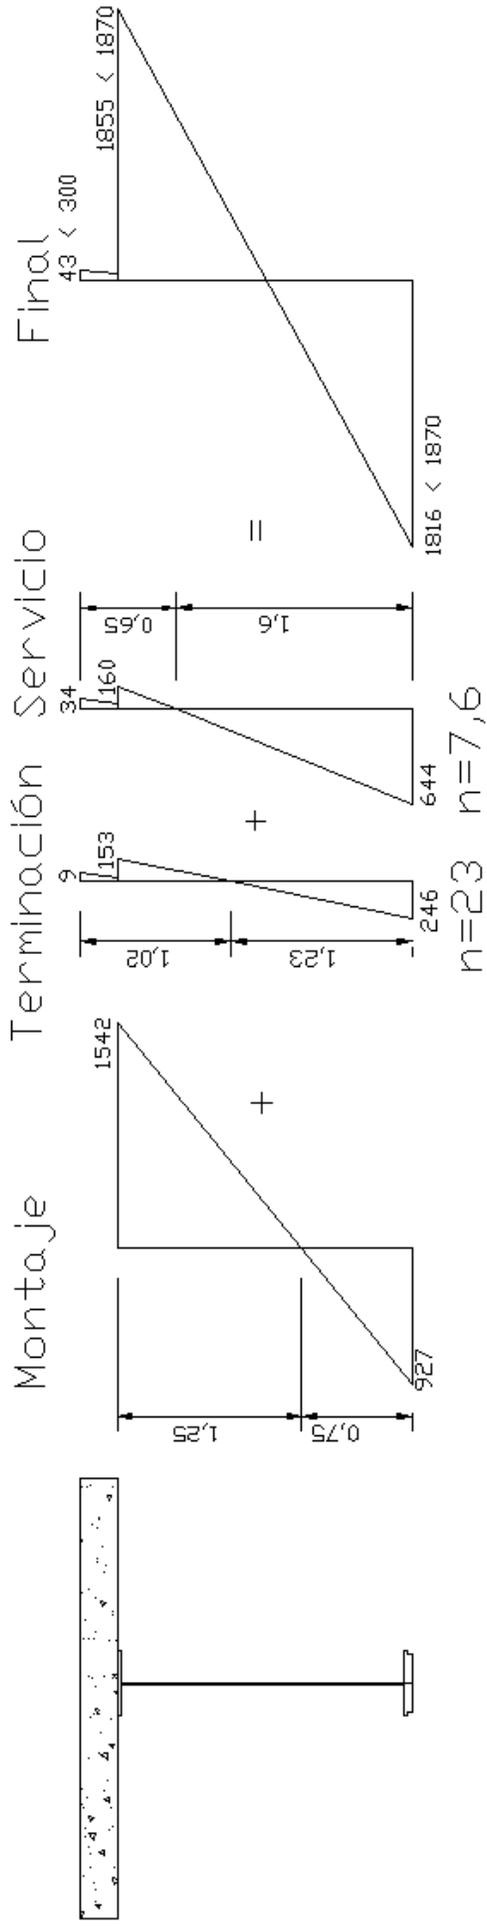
Diseño de viga metálica con losa colaborante. Verificación de tensiones en las etapas de Montaje, Terminación, Servicio y Final. Cotas en [m] y tensiones en [Kg/cm²].
